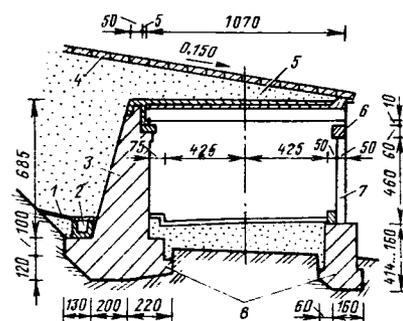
Поперечный разрез галереи на дороге Ош — Хорог: 1 — экран глиняный; 2 — лоток водоотводный; 3 — опора верховая; 4 — укрепление из бетонных плит; 5 — засыпка амортизационная; 6 — ригель; 7 — стойка низовой опоры; 8 — фундаменты опор
